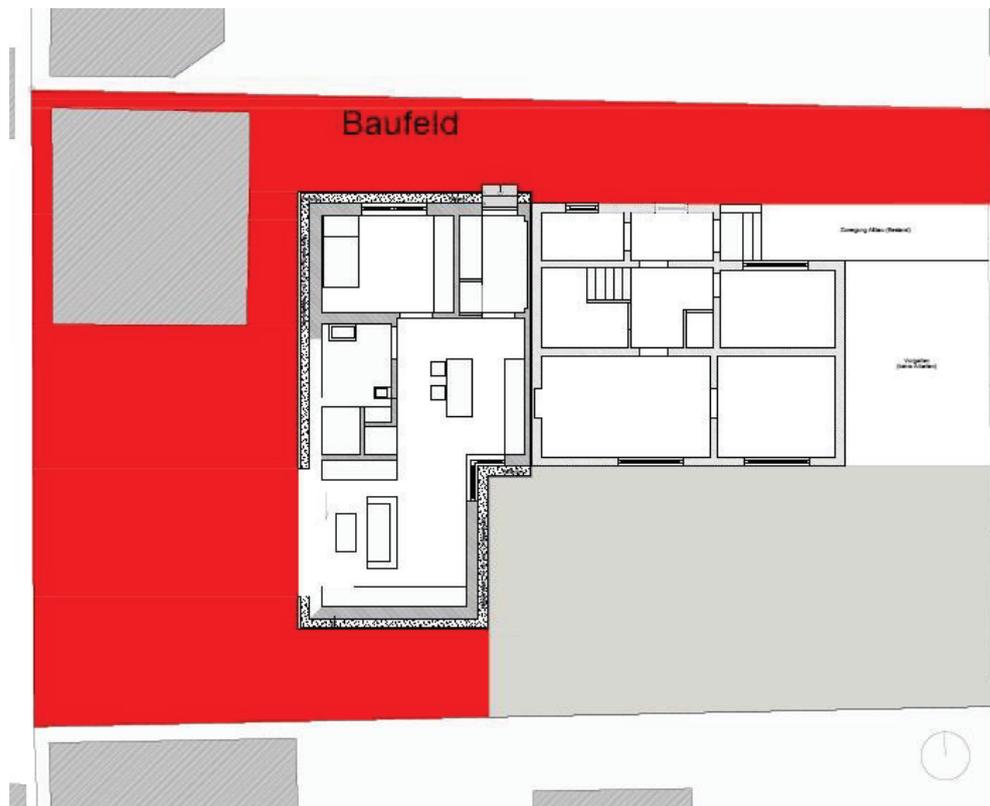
Auszug aus dem Architektenplan mit Baufeld in Rot
